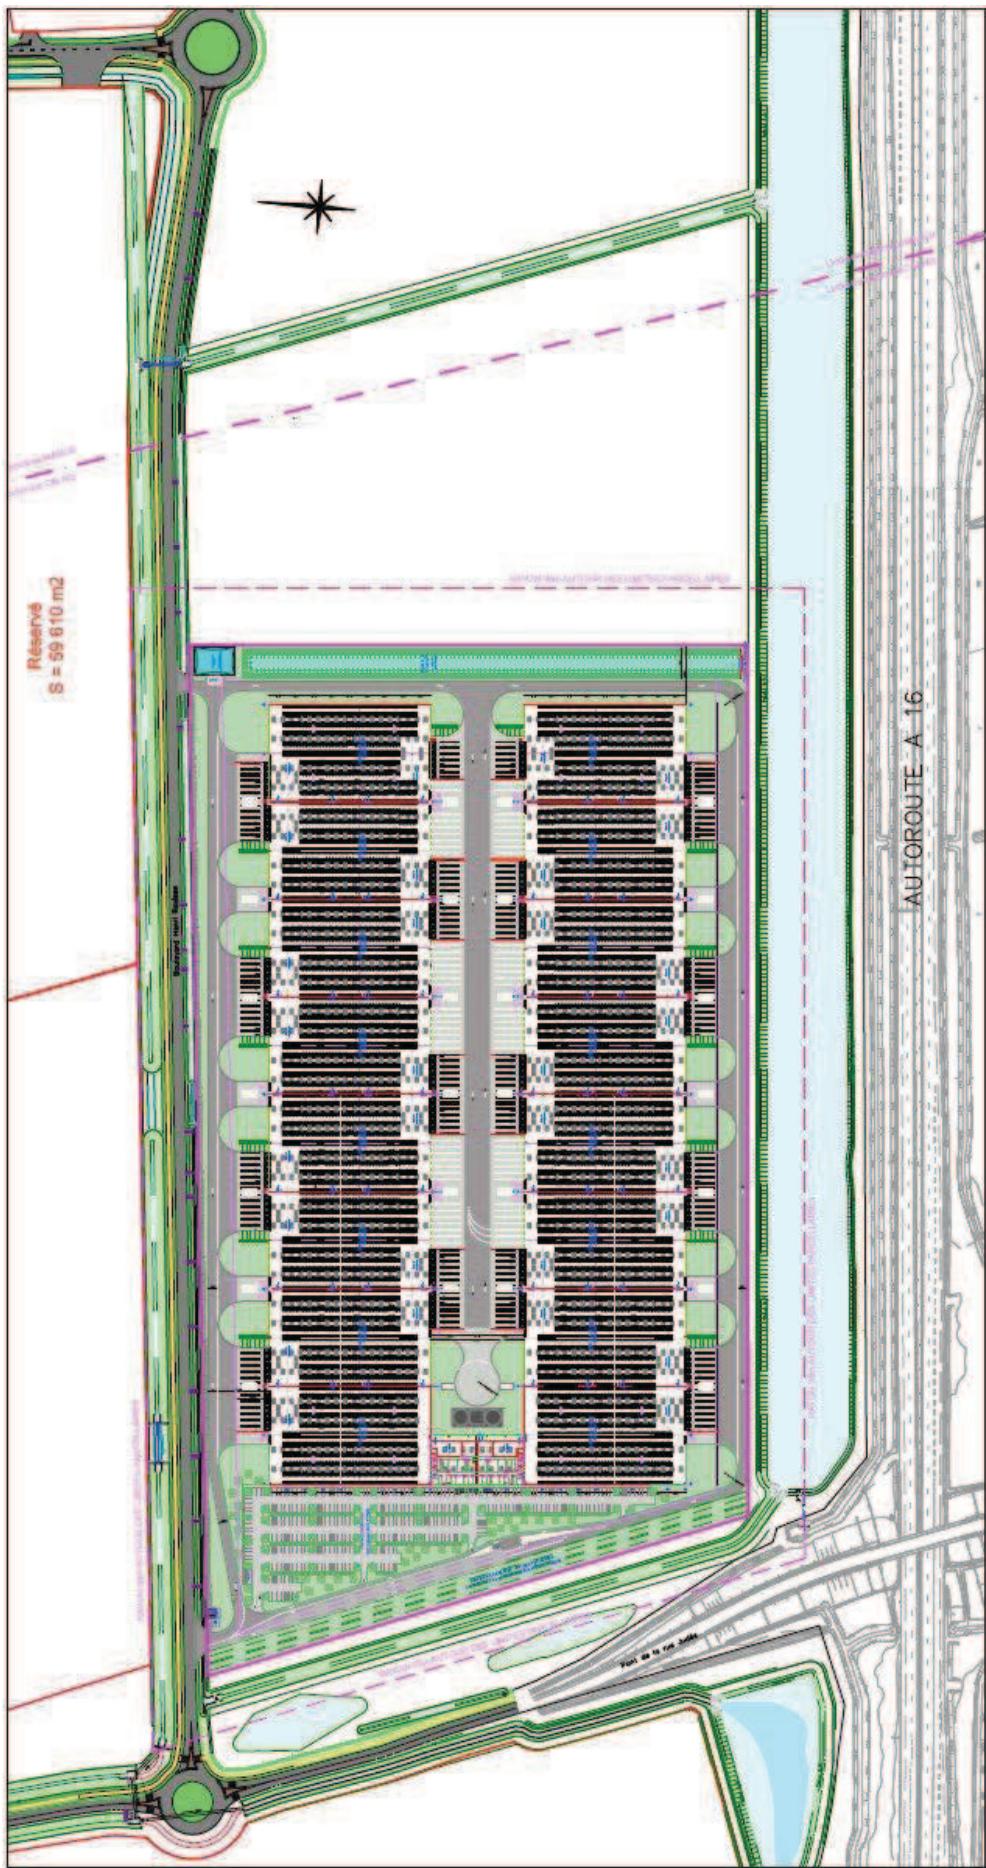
A : Plan de masse du projet initial (source : ICI, 2019)
